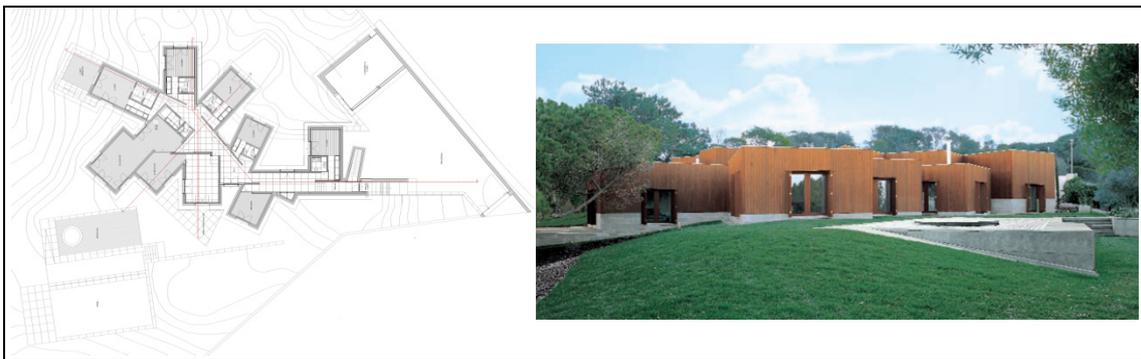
Planta e imagem da Casa do Pego de Álvaro Siza
